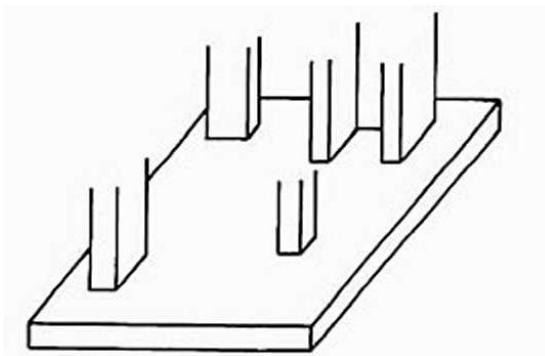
Radier – Fonte: ABMS/ABEF (1998).
